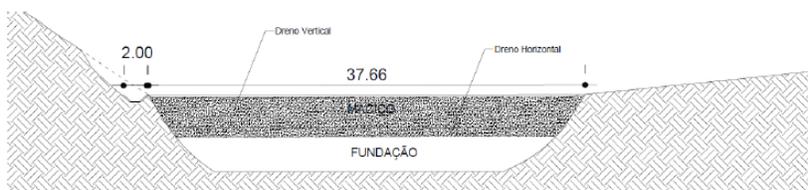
Corte B-B (Dreno, Vertedouro) – Longitudinal
